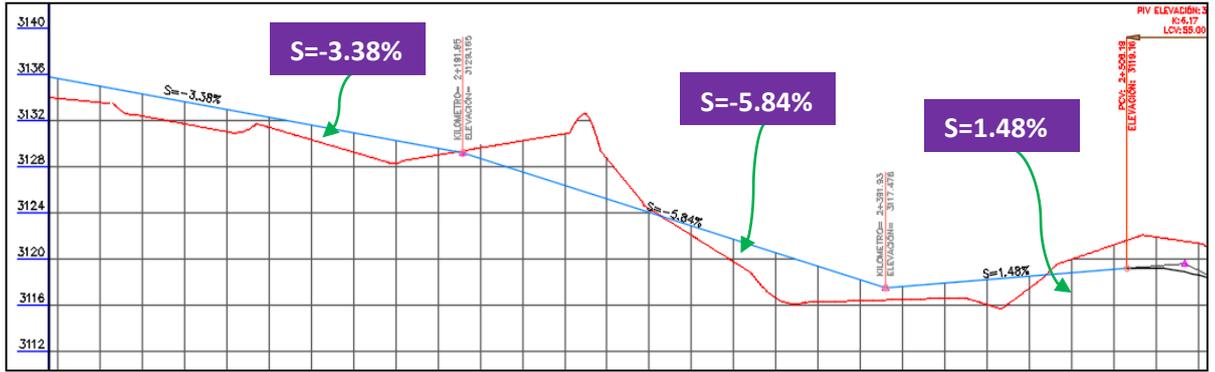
Pendientes del perfil longitudinal de la carretera
